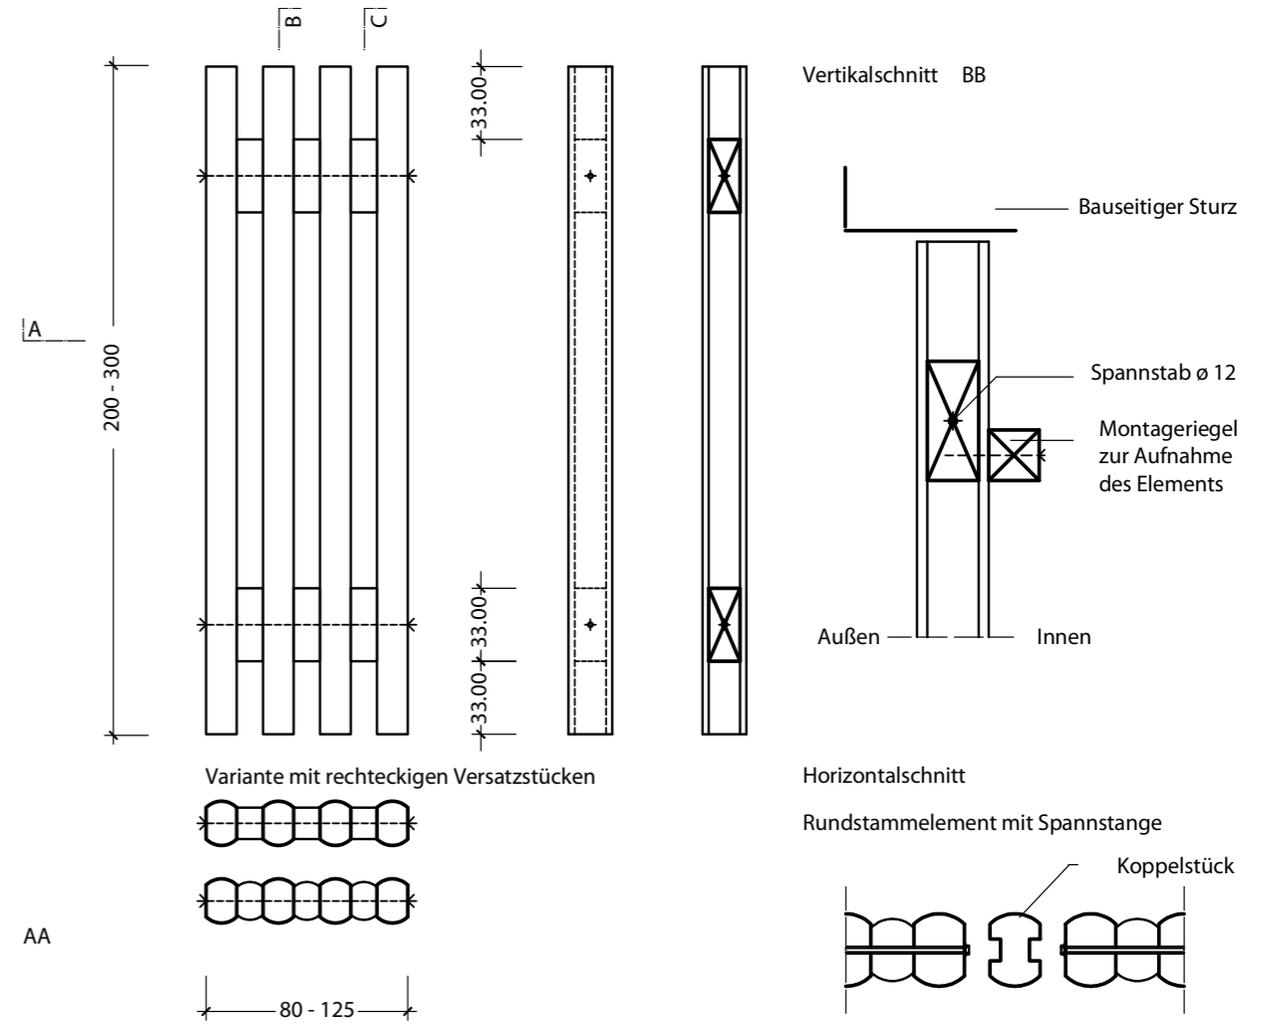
Studie Fassadenelement Rundstamm beidseitig besäumt
